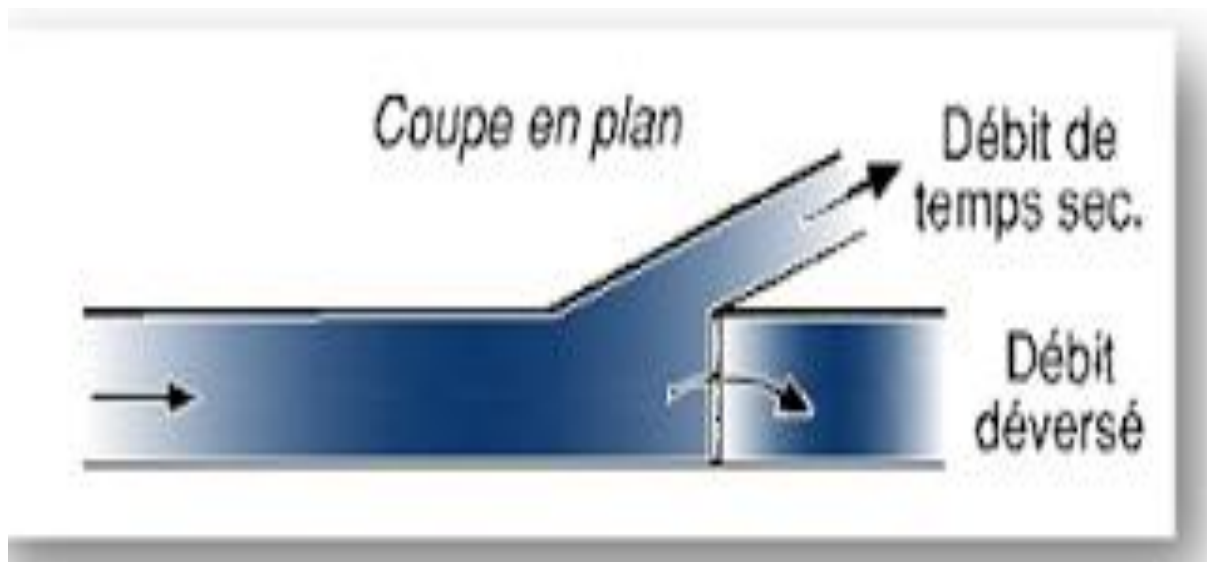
Déversoir d'orage à seuil frontal (coupe en plan) [12].
